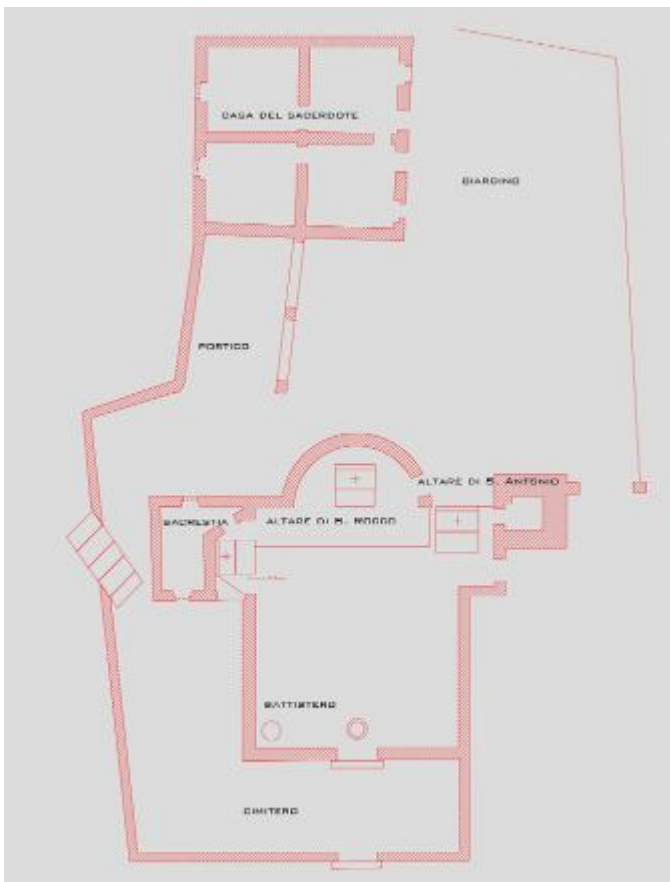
Pianta della Chiesa di S. Maria Assunta – ricostruzione su disegno datato 1578.
